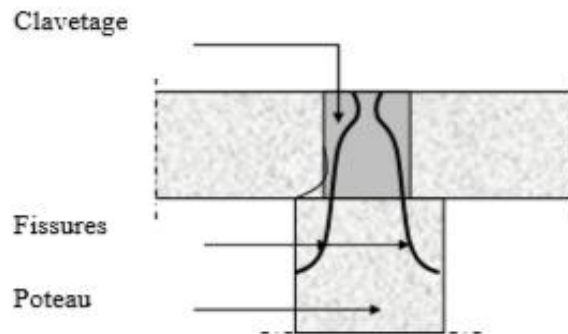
Fissures en tête de poteau servant d'appui aux poutres préfabriquées.
